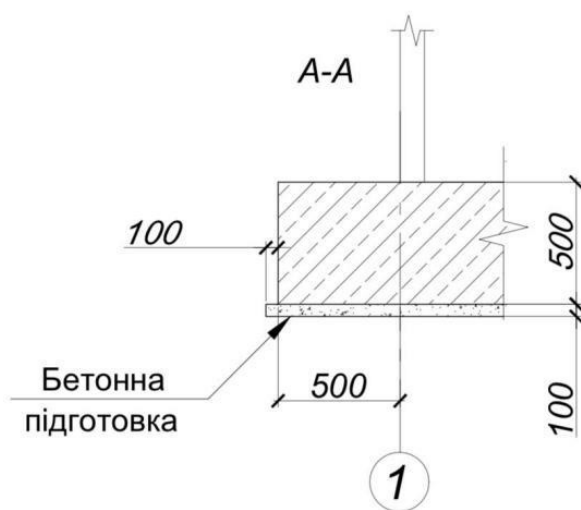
Фундаментна плита та бетонна підготовка в розрізі
